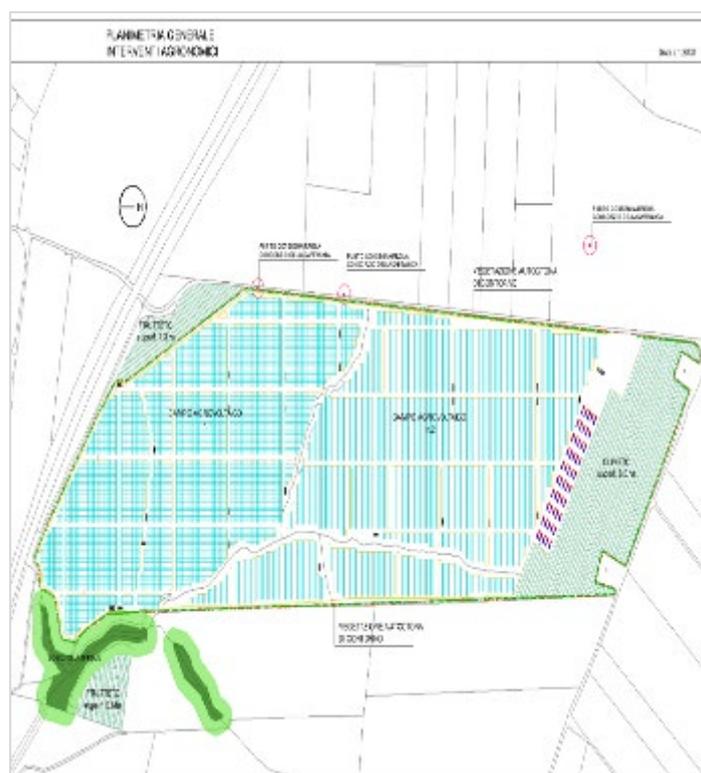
Planimetria dell'impianto fotovoltaico e degli interventi agronomici.
